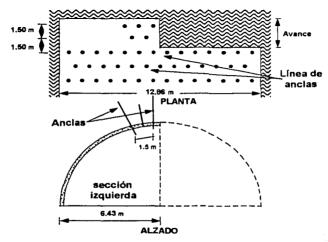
Anclaje de la sección en la zona central, utilizando elementos de 1" Ø x 4.2 m
